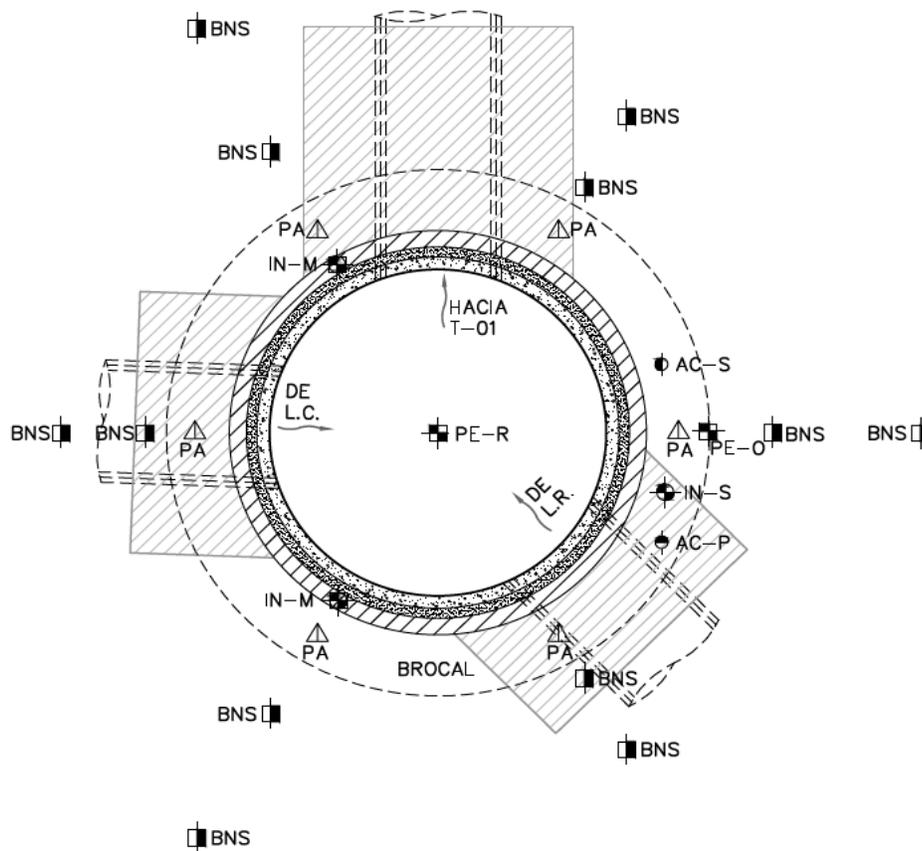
Distribución en planta de la instrumentación en lumbrera T-00.
